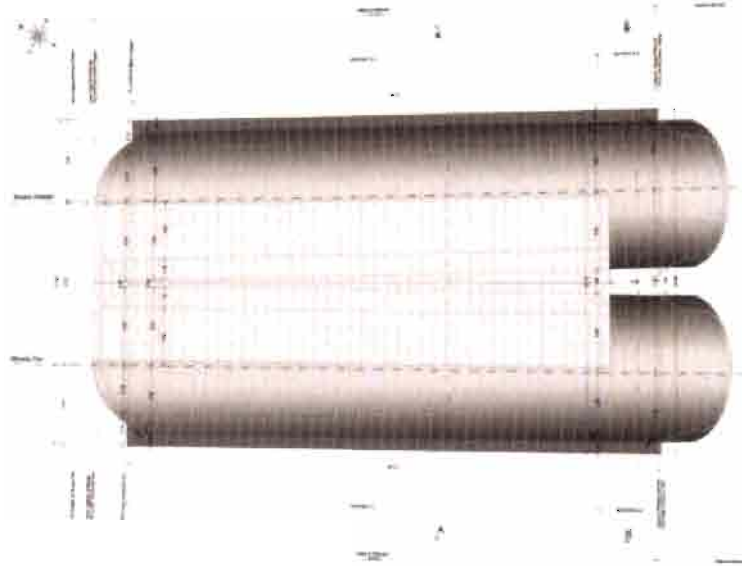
Franzensfeste: Grundriss Abdeckung Portal Schalderer-Tunnel
